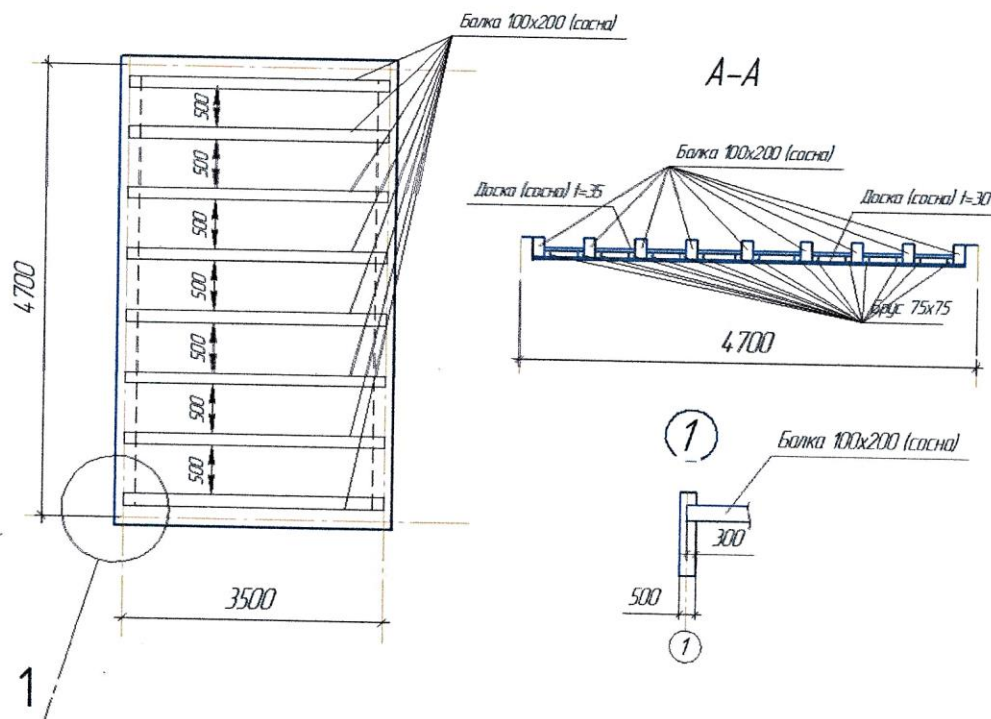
Схема расположения элементов деревянного перекрытия.
